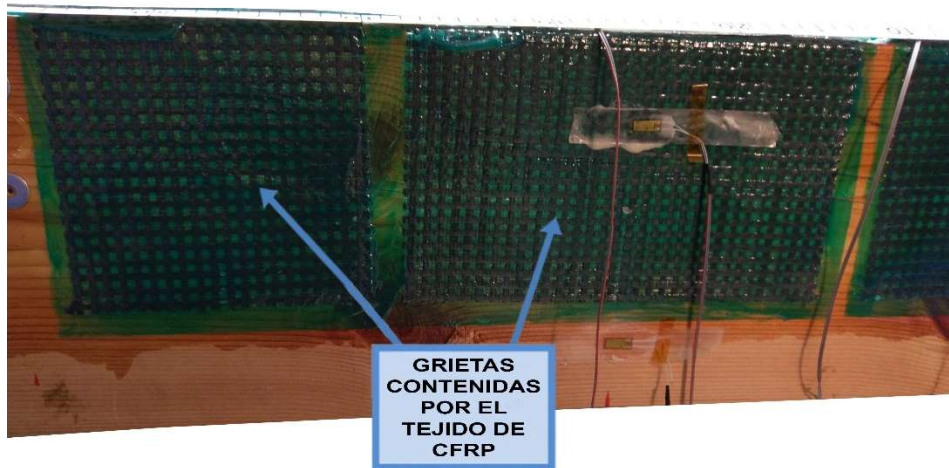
Grietas existentes contenidas por el material de CFRP de la viga BR-r-3.
